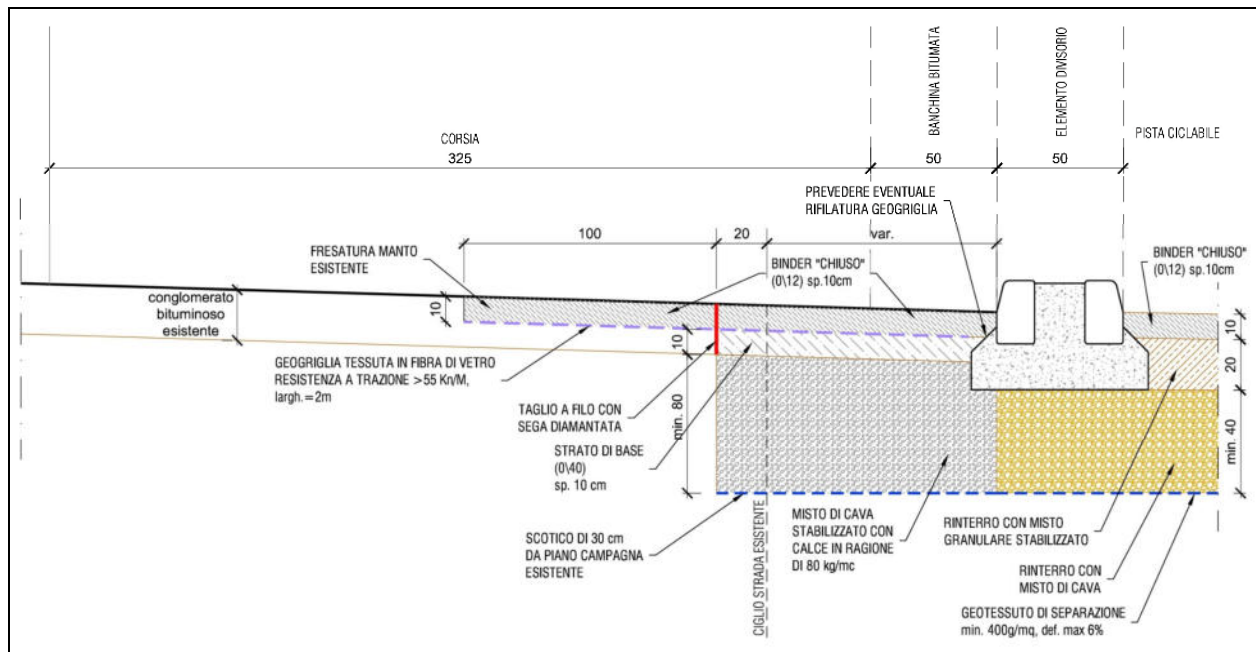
Sezione tipo per l'allargamento della sede stradale
